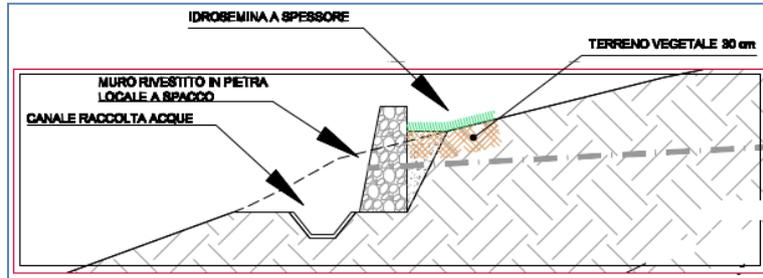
Inerbimento area lavorazione "dreni sub-orizzontali" - sezione
